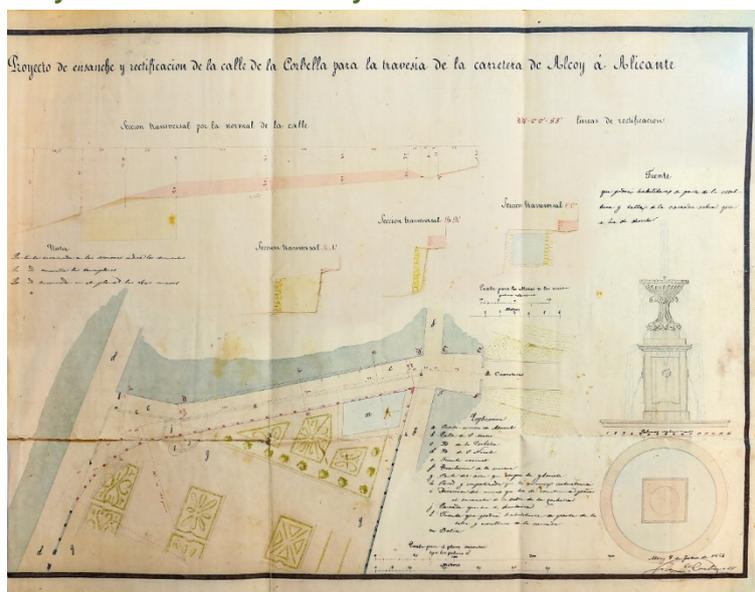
Plano de ensanche y rectificación de la calle Corbella (1854, AMA)
